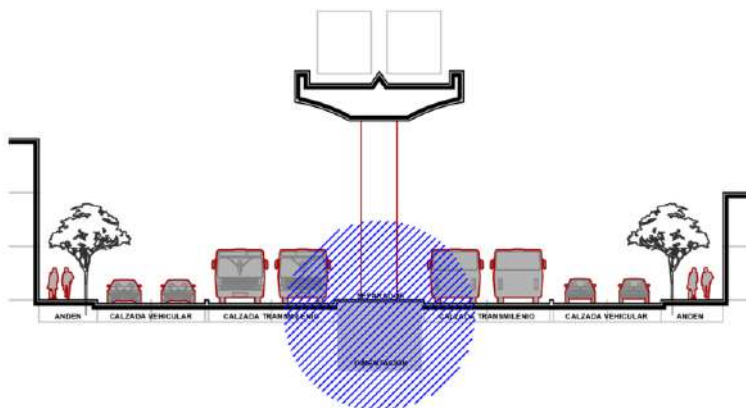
Afectación al tráfico sistema constructivo túnel entre pantallas
